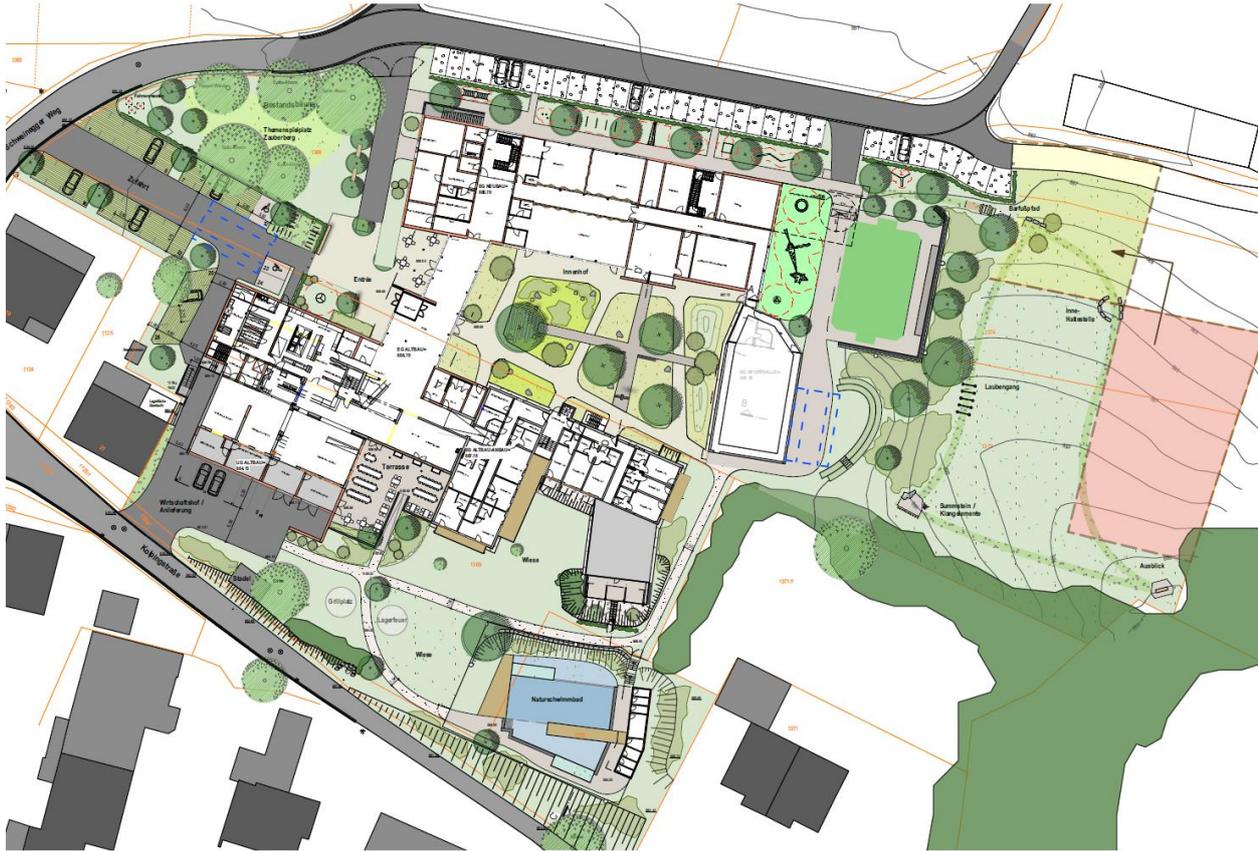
Vorentwurf Außenanlagen – © DAURER + HASSE, Wiedergeltingen
